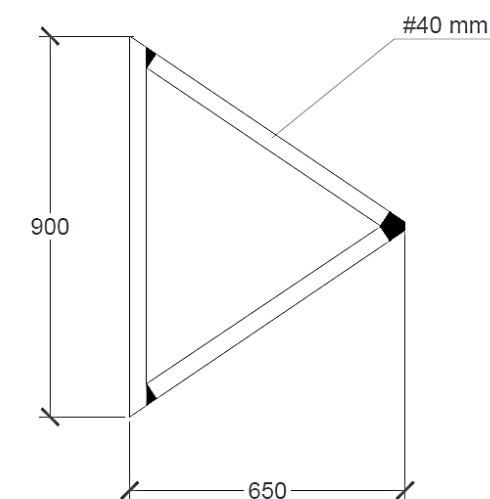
Sección transversal del arco. Elaboración propia con AutoCAD
